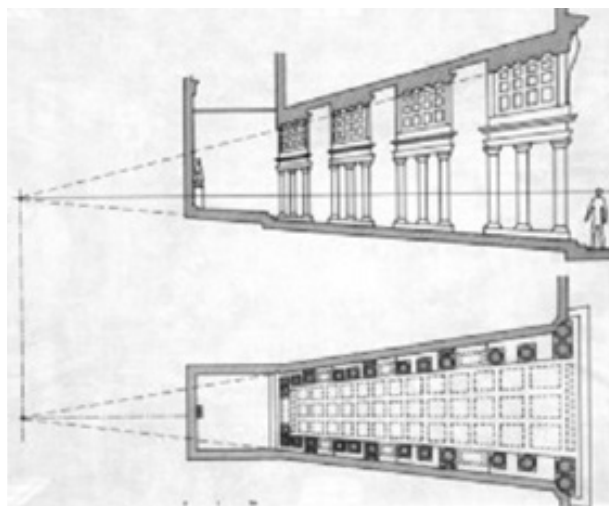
Corte e Planta da Galeria do Palazzo Spada, Roma, Borromini.
